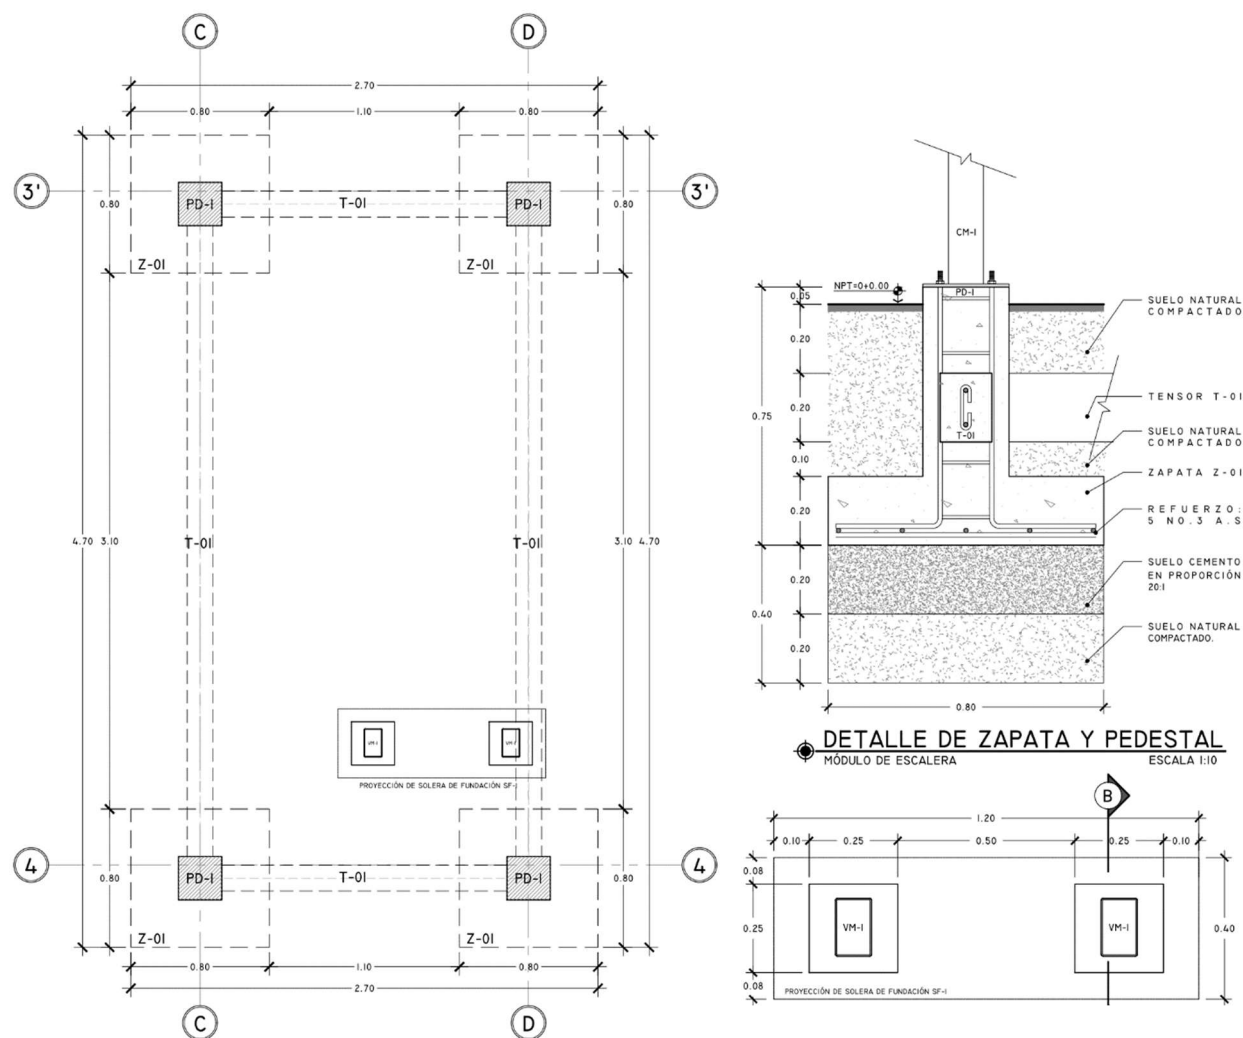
Planta de Fundaciones de Escalera de Mantenimiento. Fuente: Elaboración Propia.
